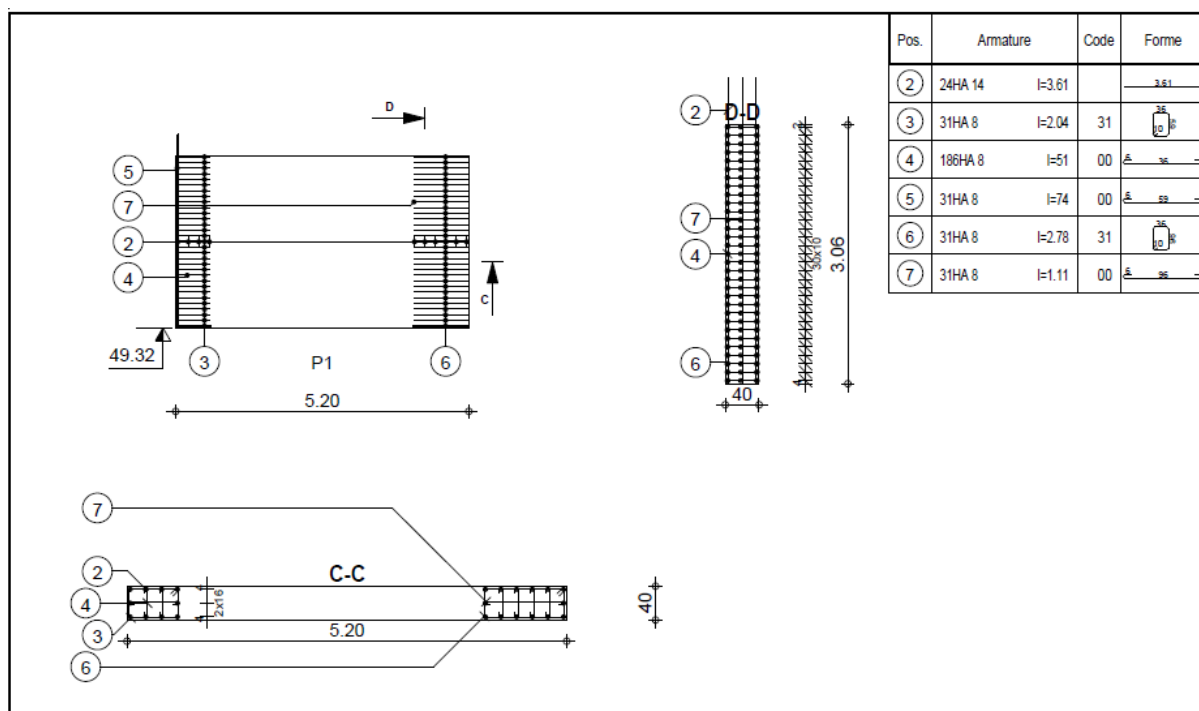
Ferrailage du voile ($L=5.20\text{m}$) coupe CC/DD
